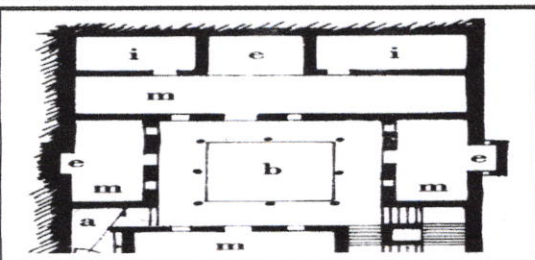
Plan d'une maison traditionnelle de la Casbah.
